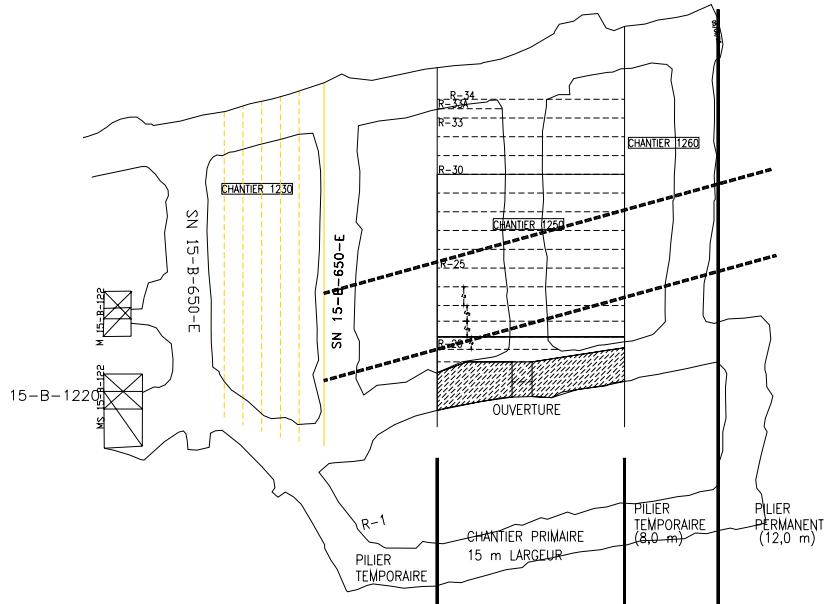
Vue en plan du chantier 15-B-1250 au sous-niveau 652
